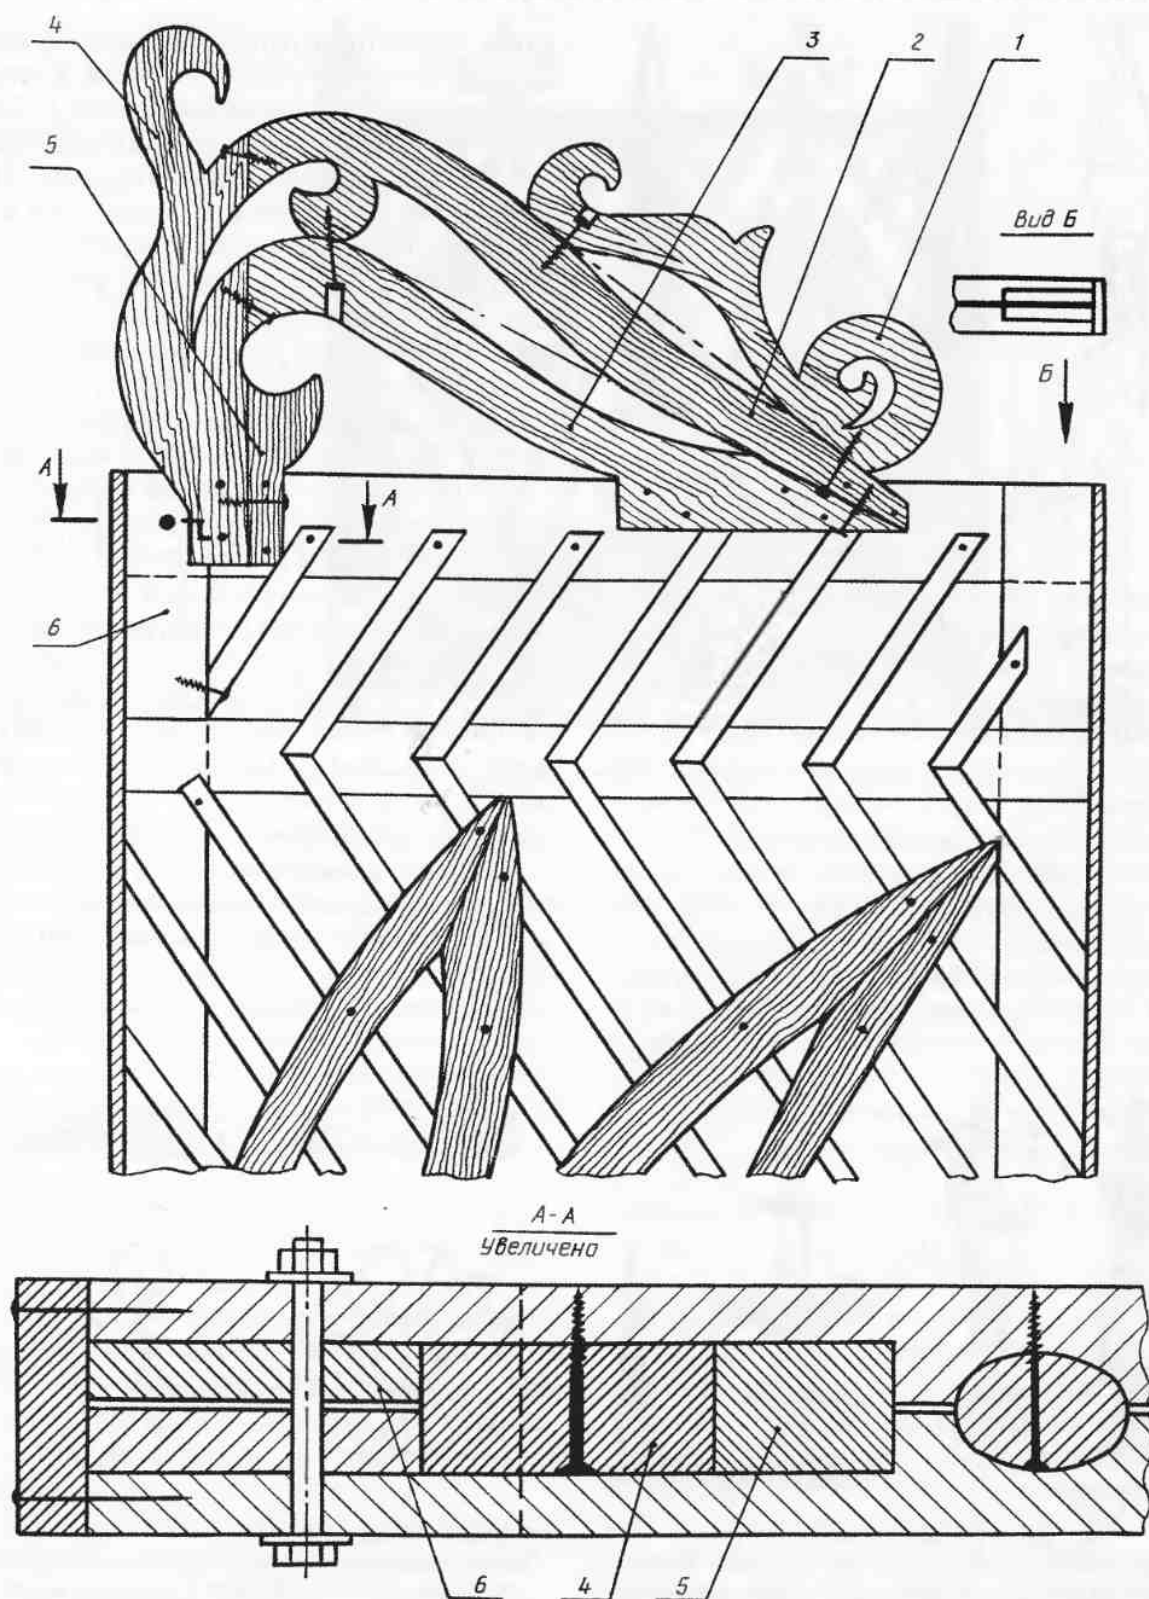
Продольный и местный поперечный разрезы верхней части ворот. Изготовление и монтаж деталей. Цифры — номера деталей
